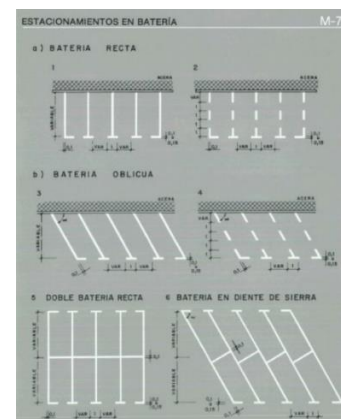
IMAGEN XVII. DELIMITACIÓN PLAZAS DE APARCAMIENTO
